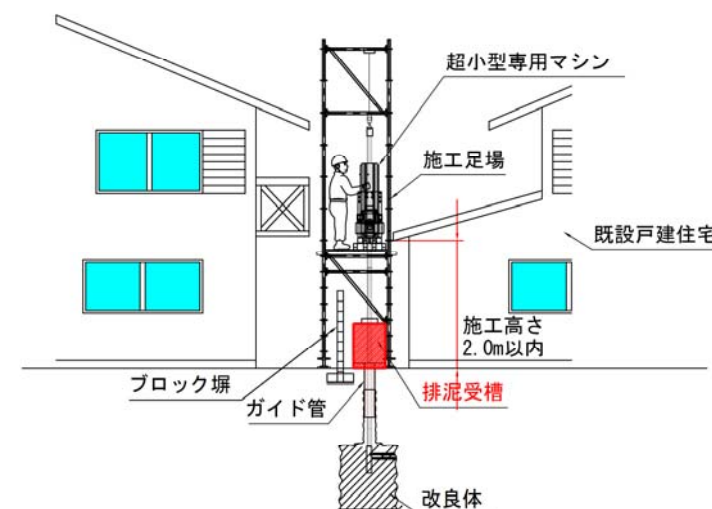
排泥受槽を設置した施工例(施工足場併用時の例)
